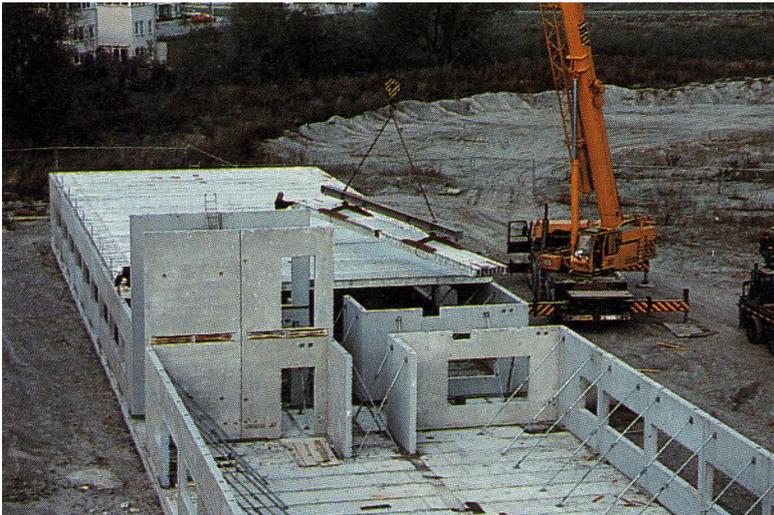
Tafelbauweise mit tragenden Wandscheiben [33]
